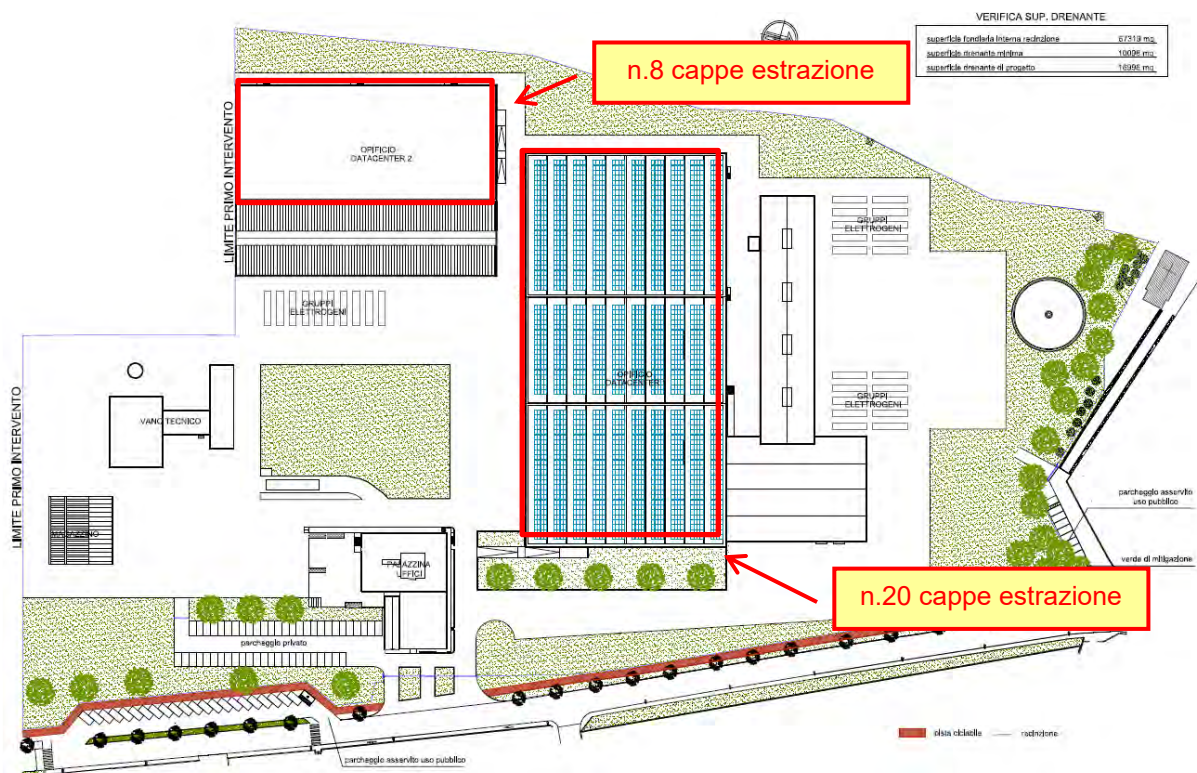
Stralcio planimetrico progetto Aruba con indicazione delle cappe di estrazione presenti.
